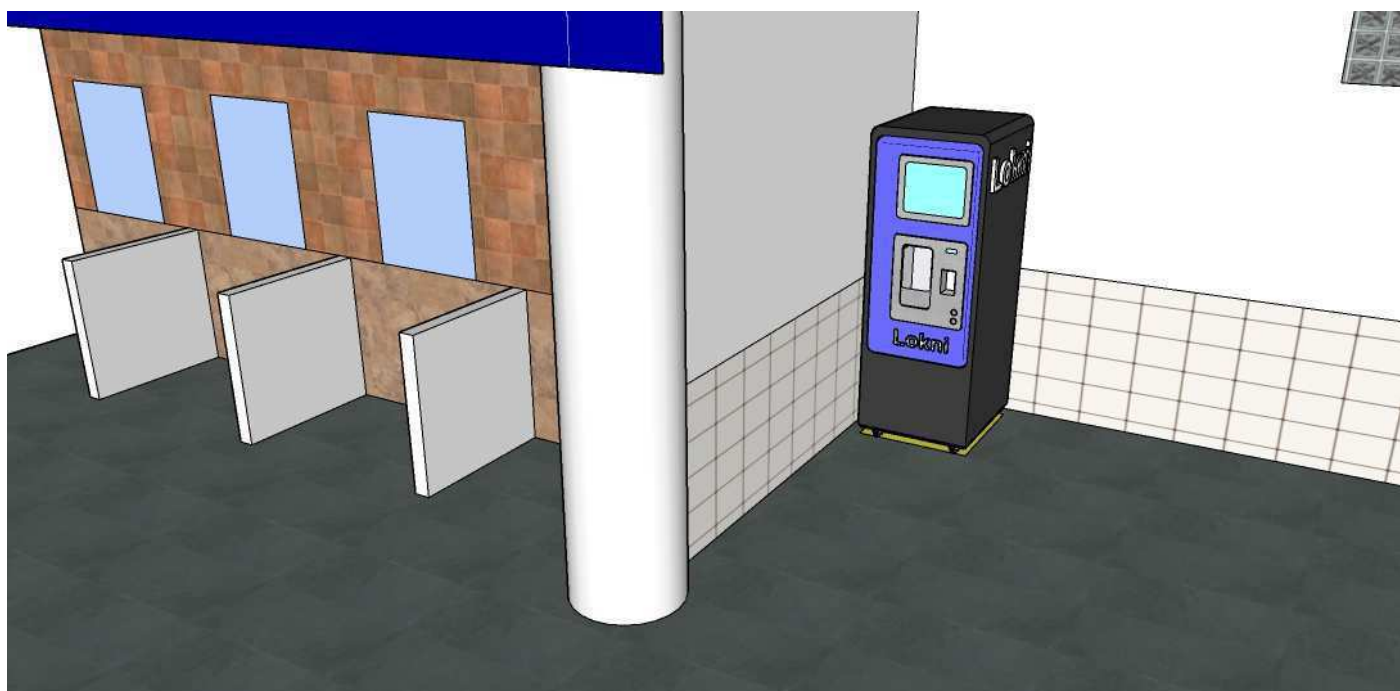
přípravy v prostoru umístění zařízení – pouze změna umístění již zhotovené zásuvky oproti reálné přípravě
